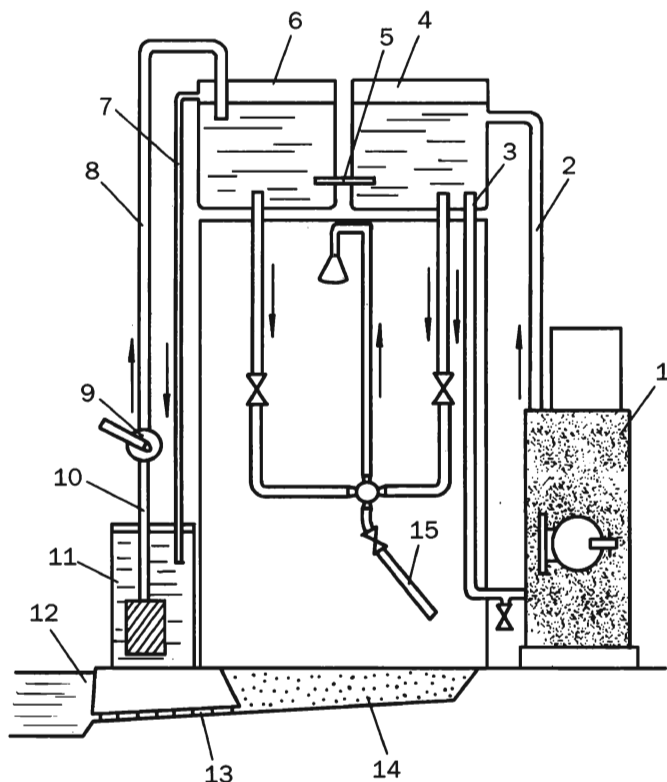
Устройство летнего душа (вариант 2): 1 — водонагреватель; 2 — восходящая труба; 3 — нисходящая труба; 4 — напорный бак; 5 — соединительная труба; 6 — напорный бак холодной воды; 7 — контрольная сливная труба; 8 — напорная труба; 9 — ручной насос; 10 — водозаборная труба; 11 — питательный бак; 12 — сточная яма; 13 — сточная труба; 14 — прямок; 15 — шланг для мытья ног
